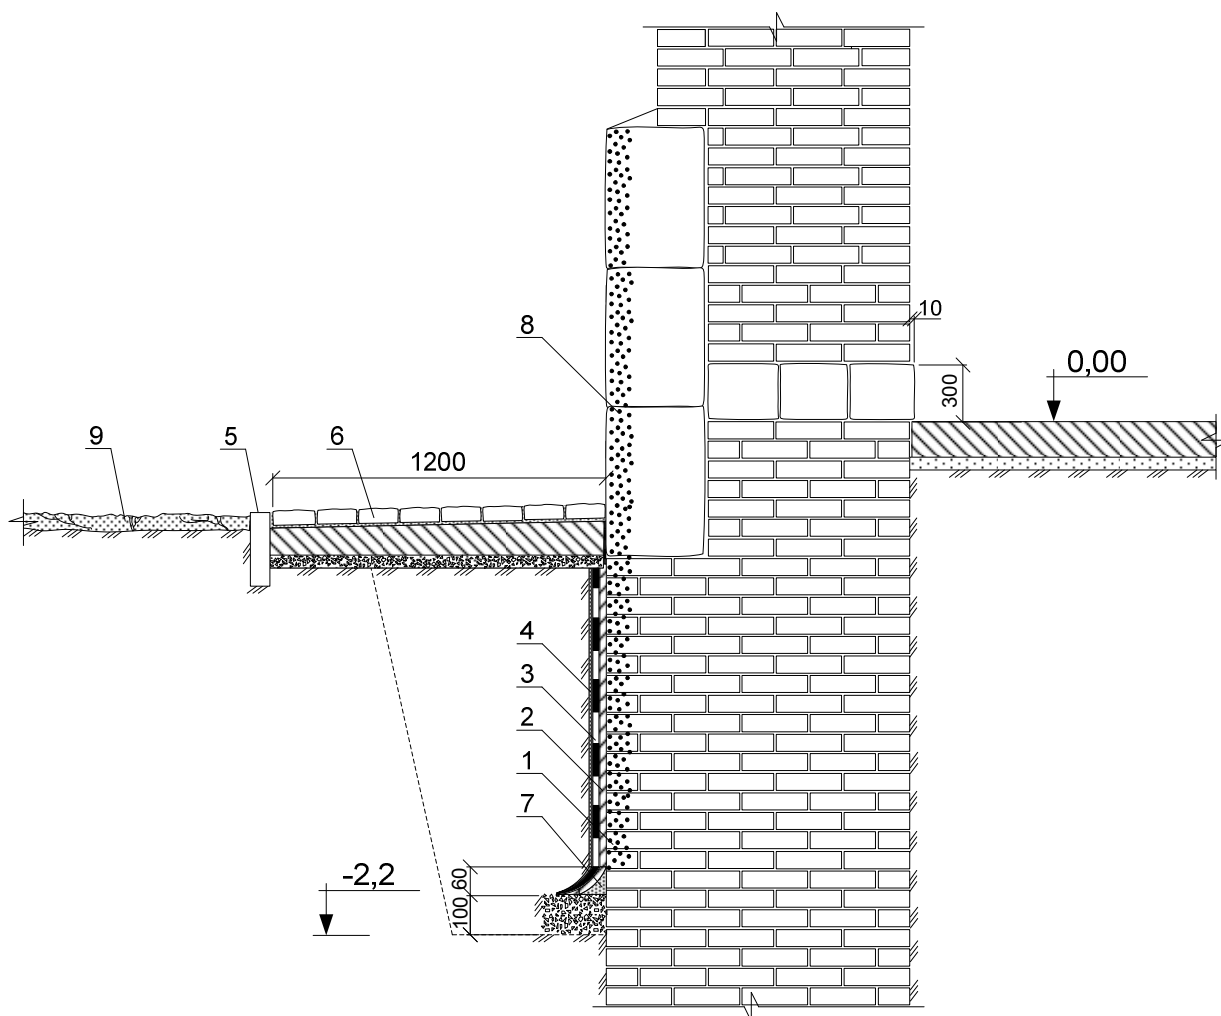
Схема влаштування вертикальної гідроізоляції цегляних фундаментів:
